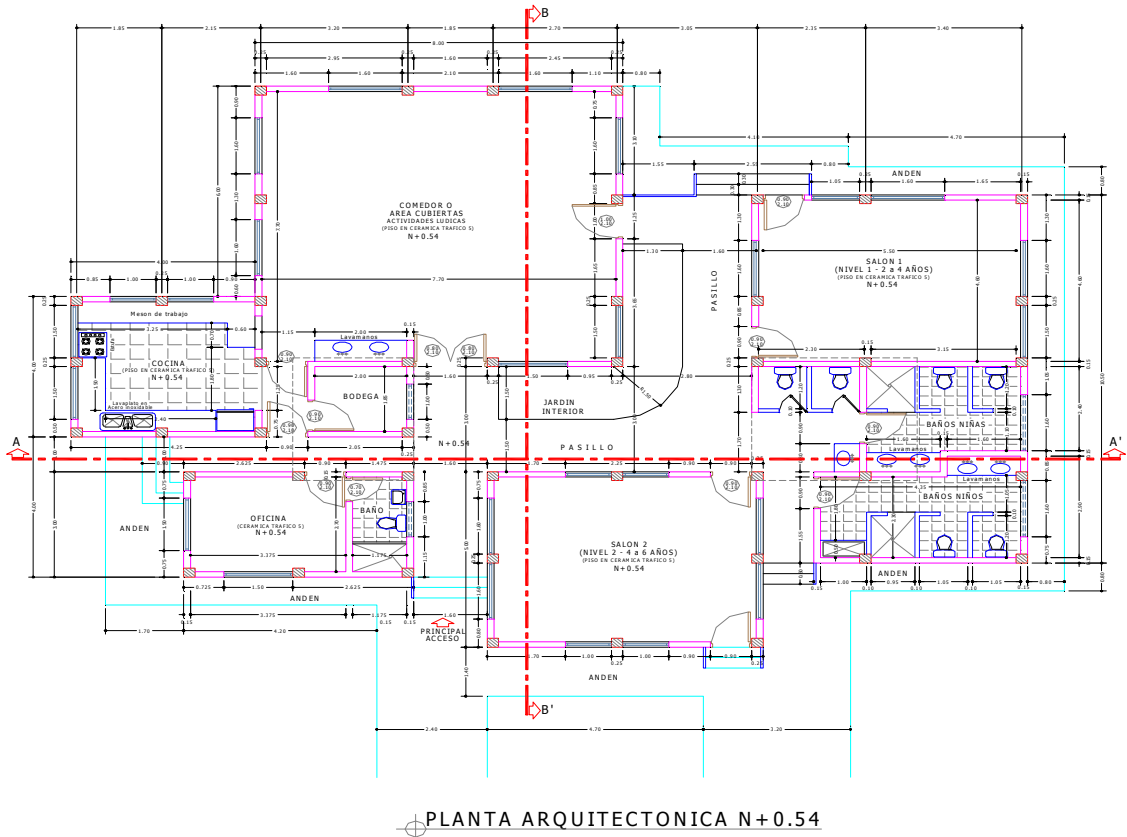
Planta Arquitectónica, Hogar Infantil La Florida.
